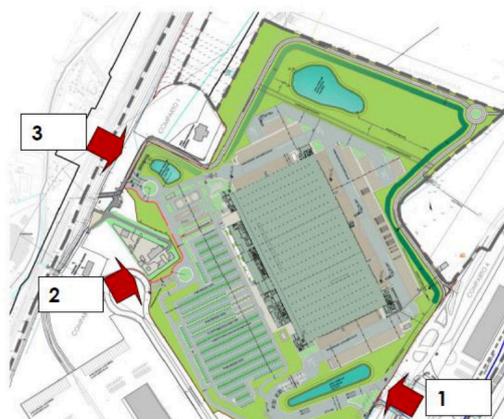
schema planimetria generale con indicazione accessi al comparto 2
